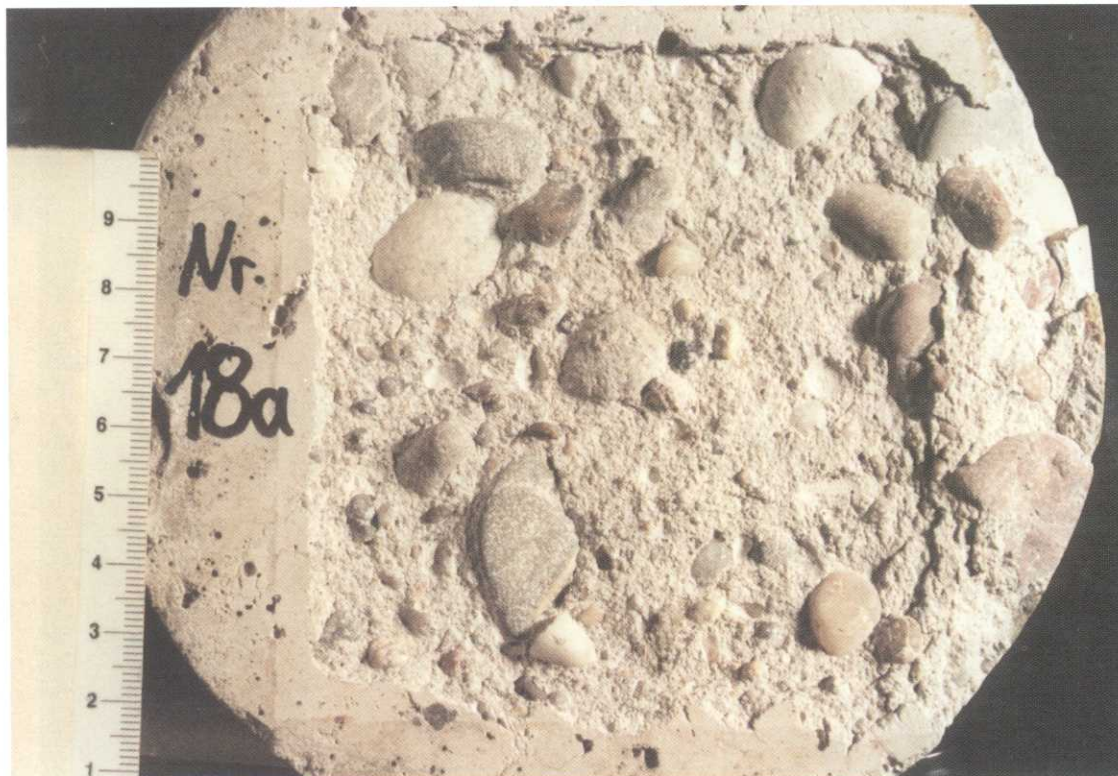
Untersuchungsabschnitt II Frost-Tausalzbeanspruchter Ausschnitt einer ohne ZEMDRAIN-Schalungsbahn, 45°-Überkopf hergestellten Betonoberfläche. (3 Tage nachbehandelt). 17 Frost-Tauwechsel.
